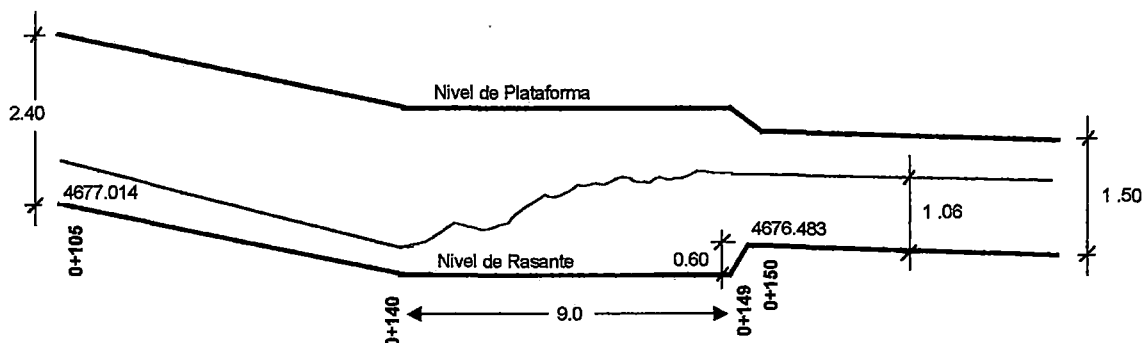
Perfil Longitudinal de la Estructura de Entrada del Canal
